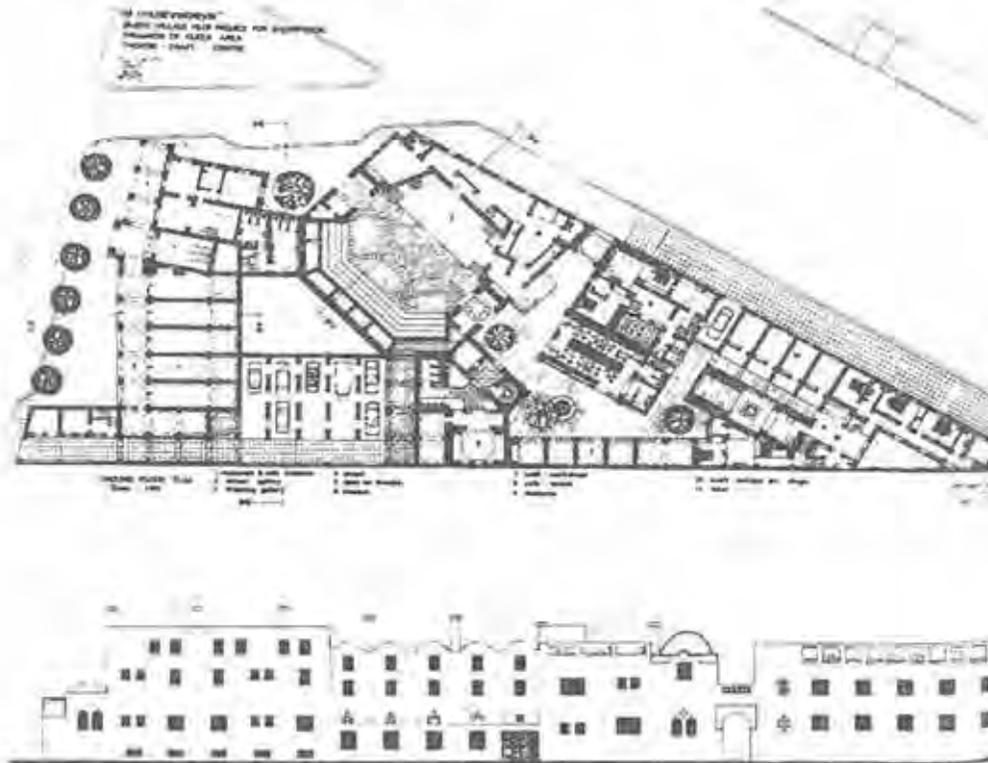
Grundriß und Fassade des Mashrabeja-Touristikzentrum in Gizeh, bei Kairo
